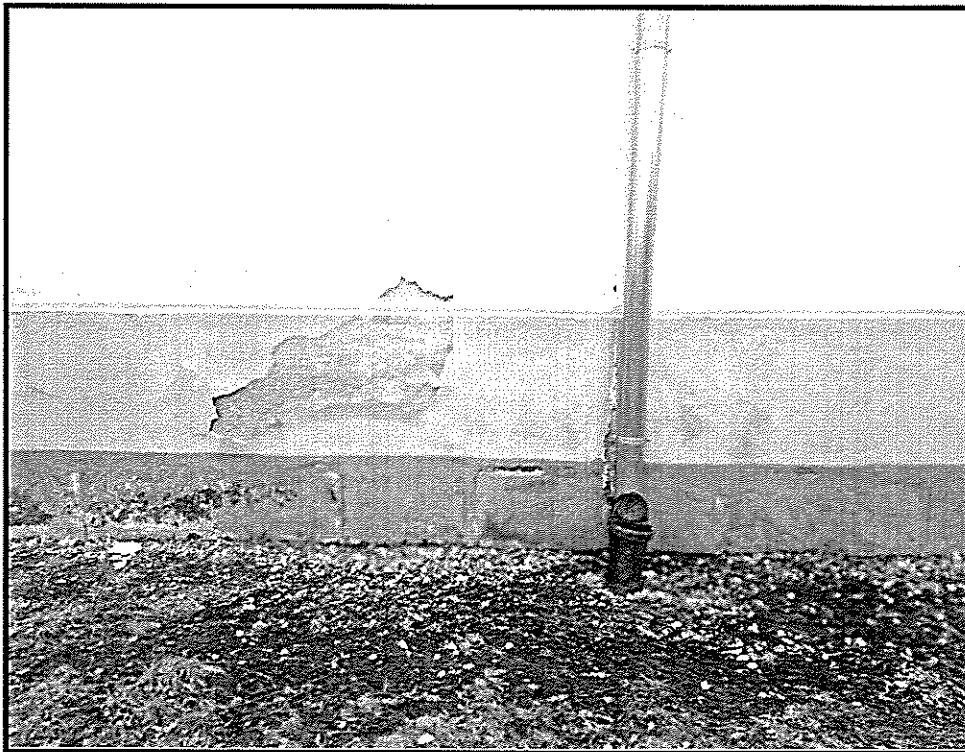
Stan zachowania elewacji wschodniej kościoła w Regnowie.
